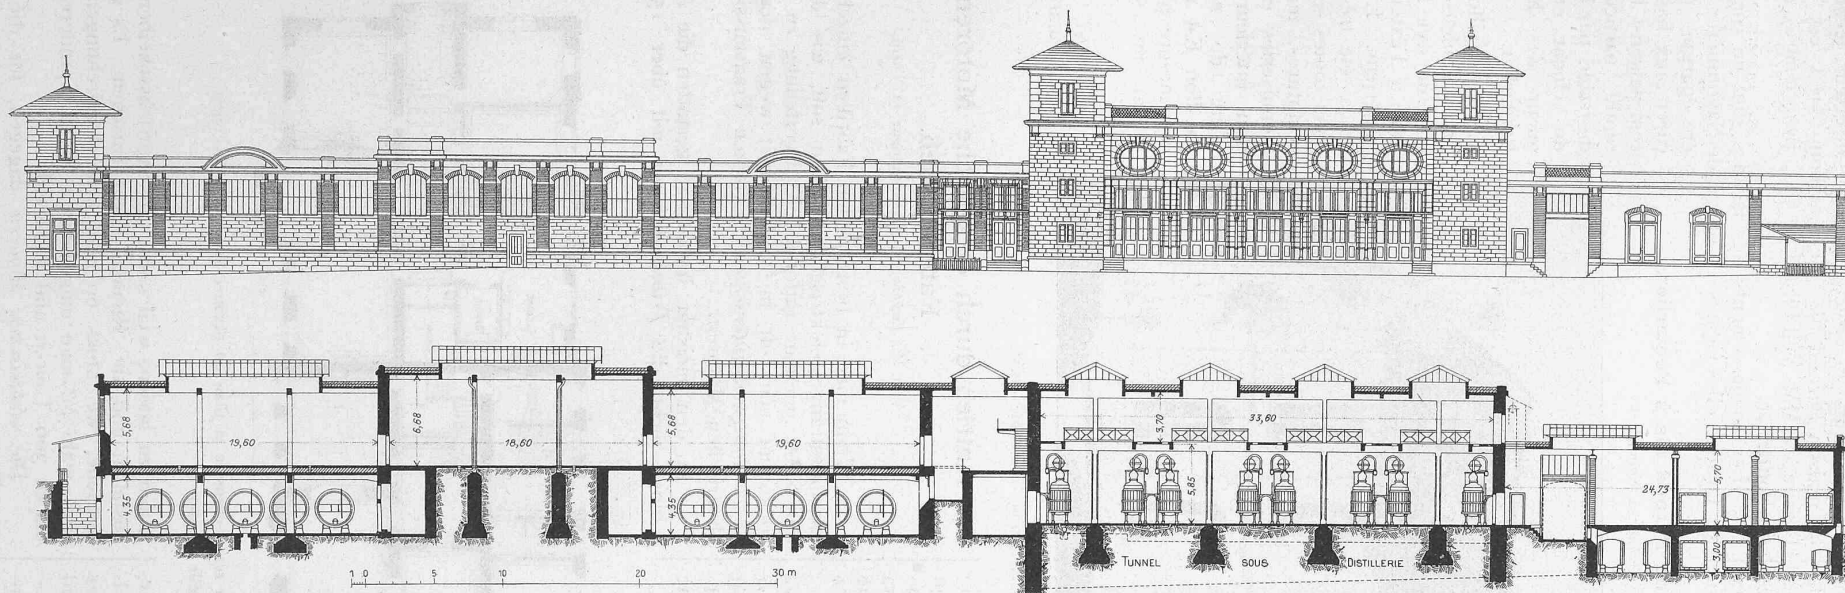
et 7. Façade sud et coupe longitudinale. — Echelle 1 : 500.
